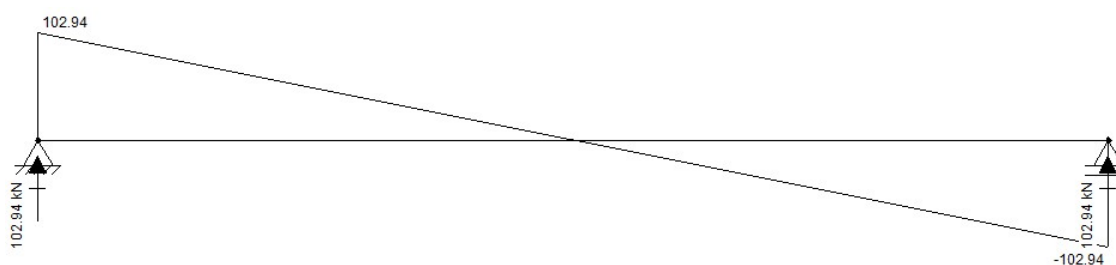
Reações de apoio da viga V4 do teto do 3º pavimento
